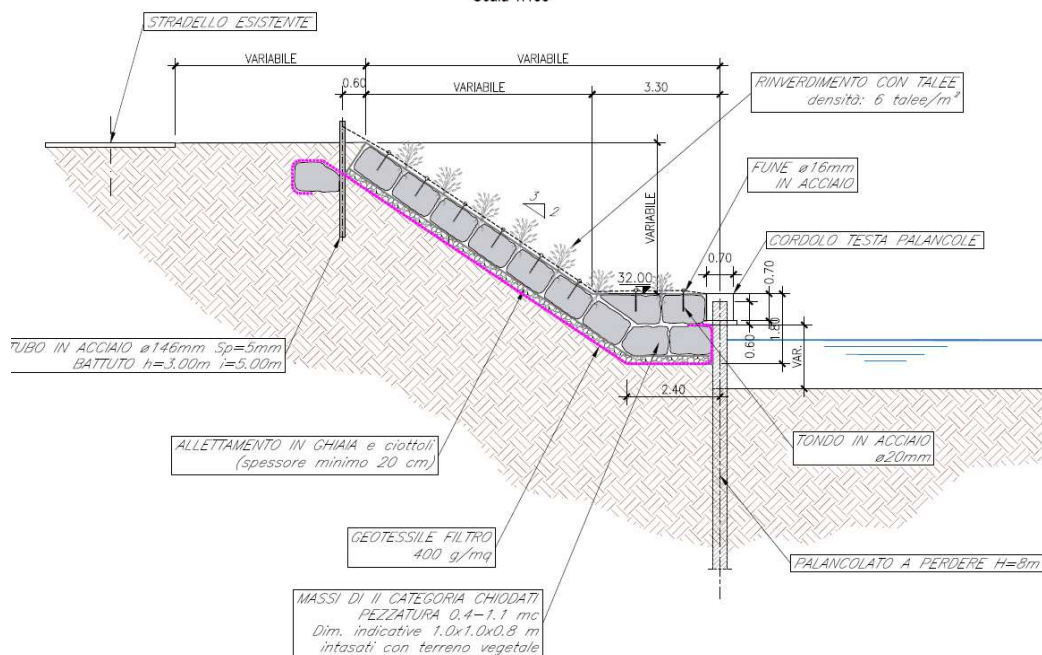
"Sezione della sistemazione di progetto sulla sponda sinistra "
